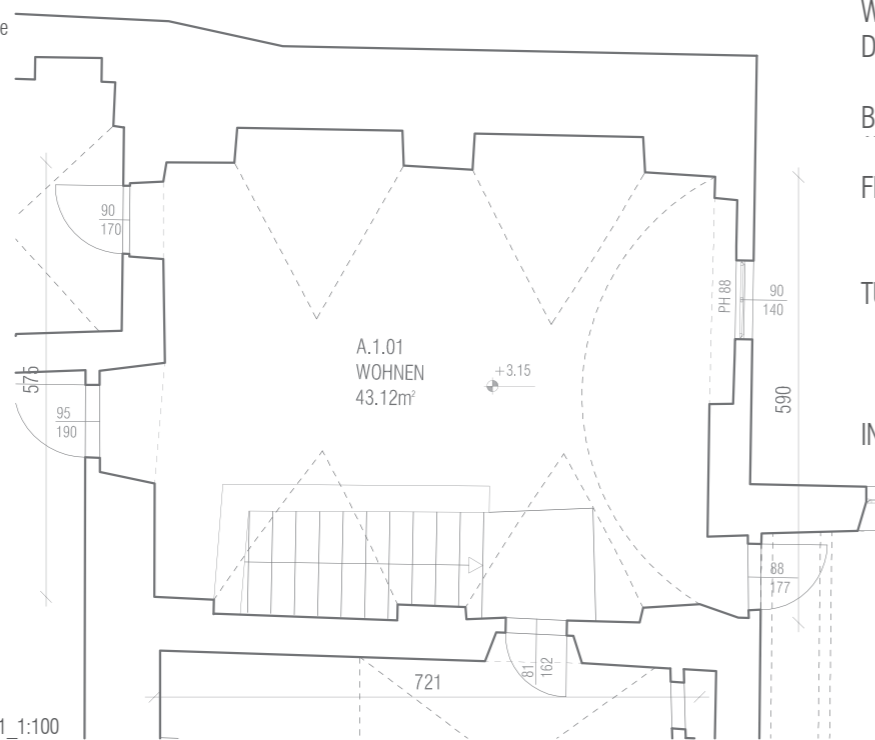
Grundriss Raum A.1.01_1:100
